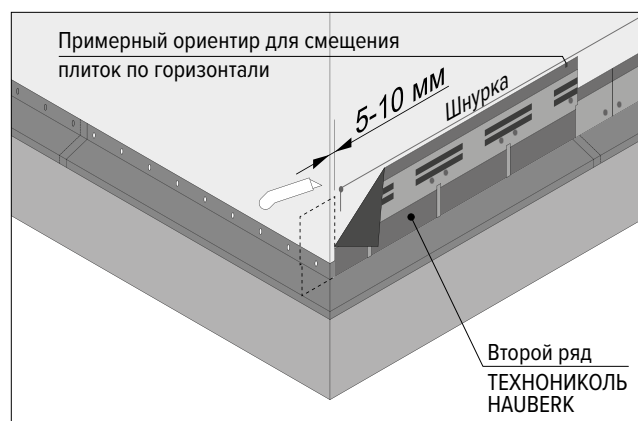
Монтаж первого и последующих рядов фасадной плитки
